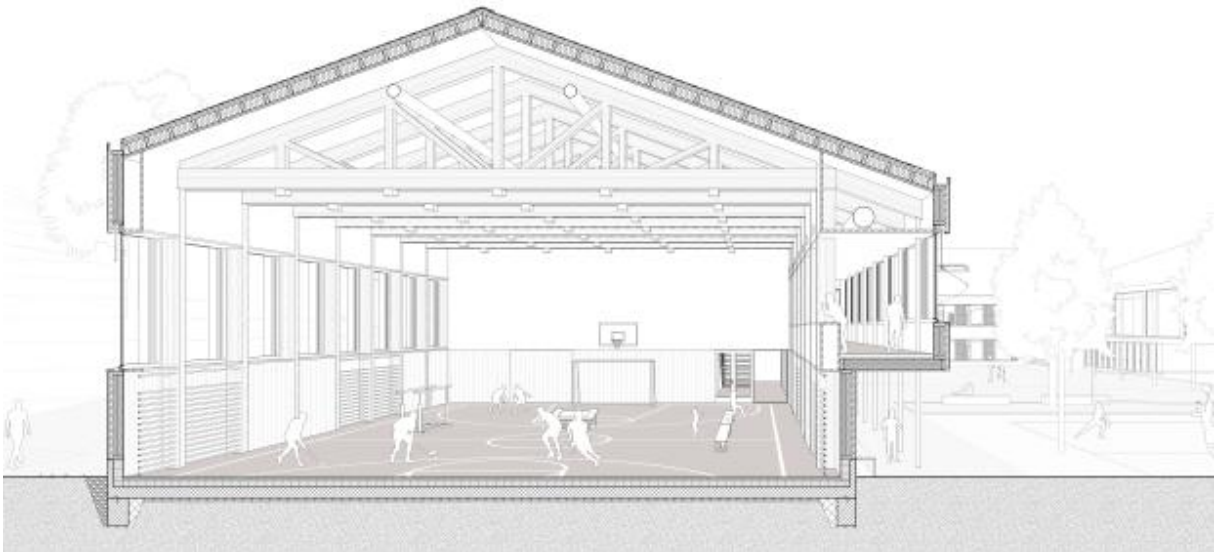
Konstruktionsschnitt Neubau Turnhalle
